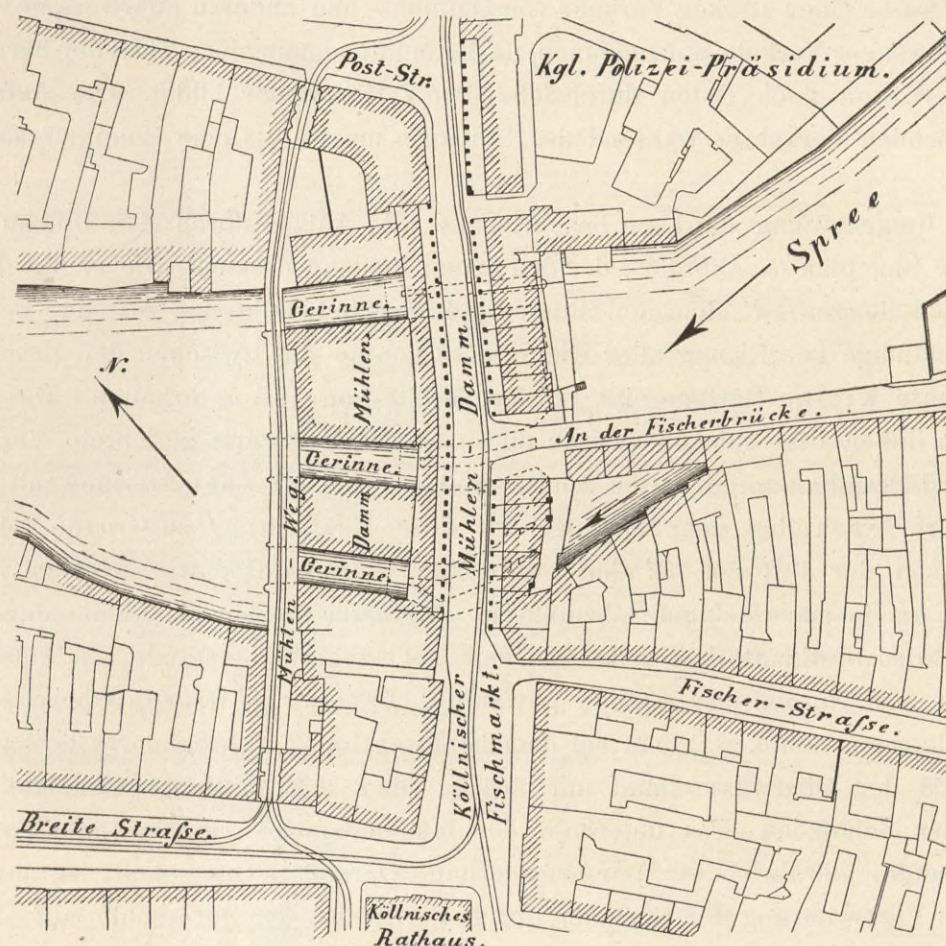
Lageplan des Mühlendammes vor dem Umbau.
